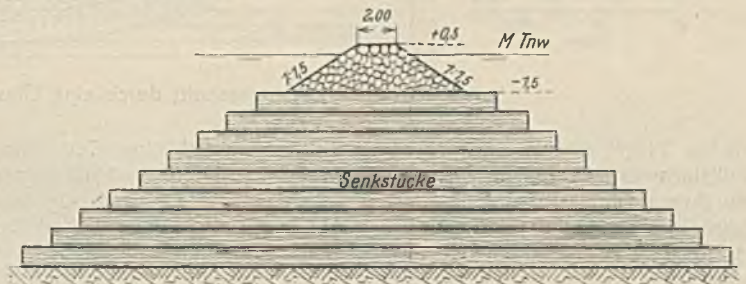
Querschnitt durch ein Stack. Geplante Ausführung.
